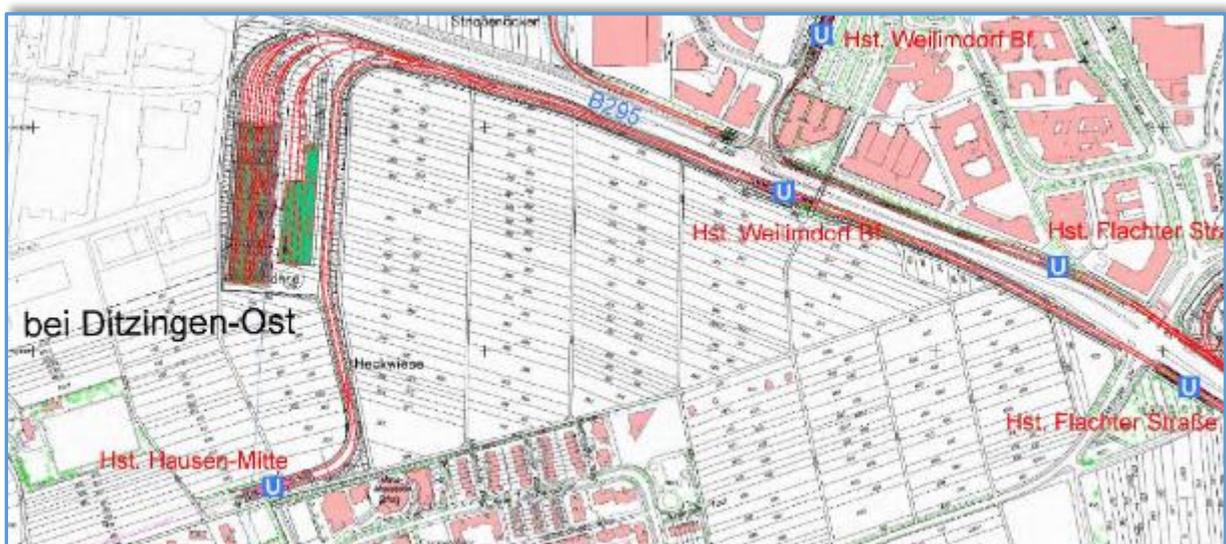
Lageplan des Standorts bei Ditzingen-Ost
